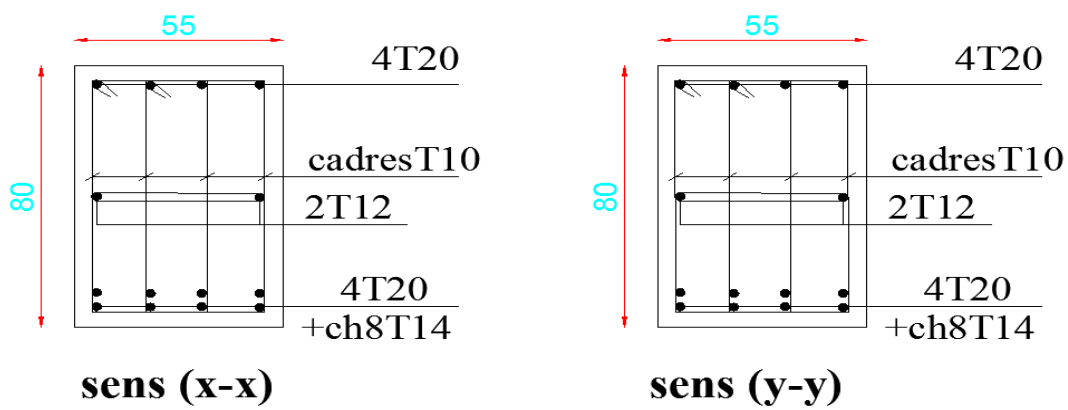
Schéma de ferrailage de la nervure sur appui et en travée
